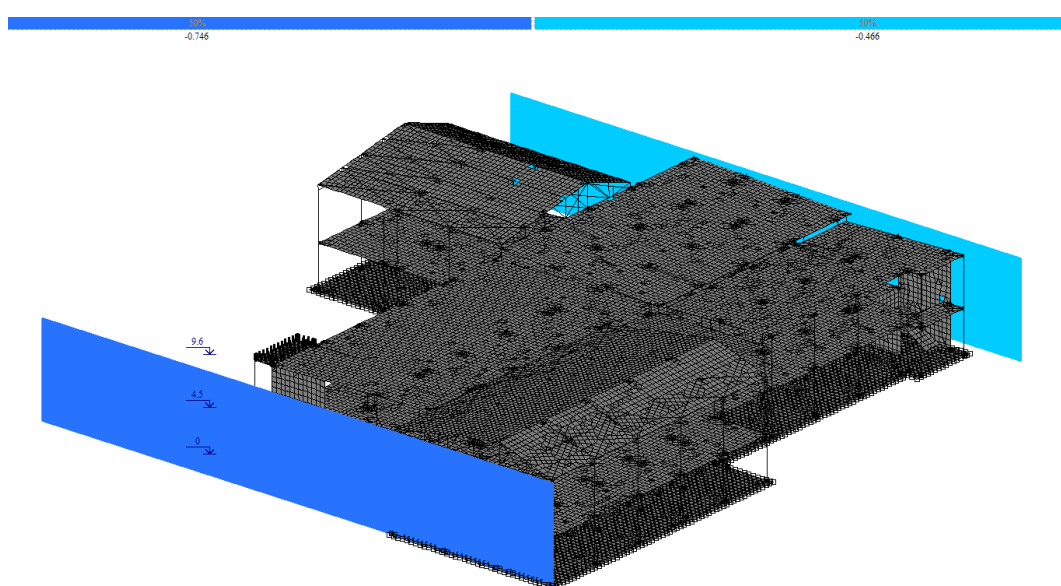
Ветровые нагрузки по оси X на торцевые стены
